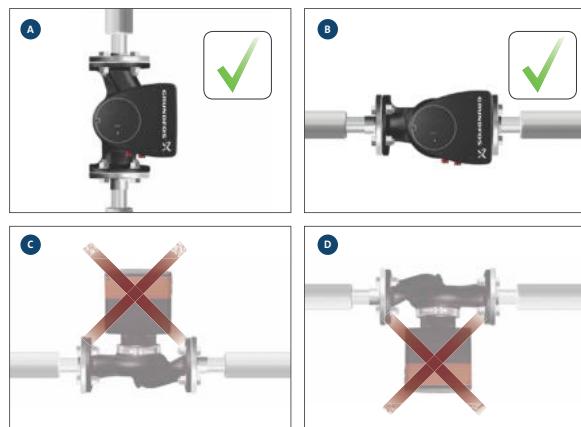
Pumpe mit horizontal ausgerichteter Motorwelle
